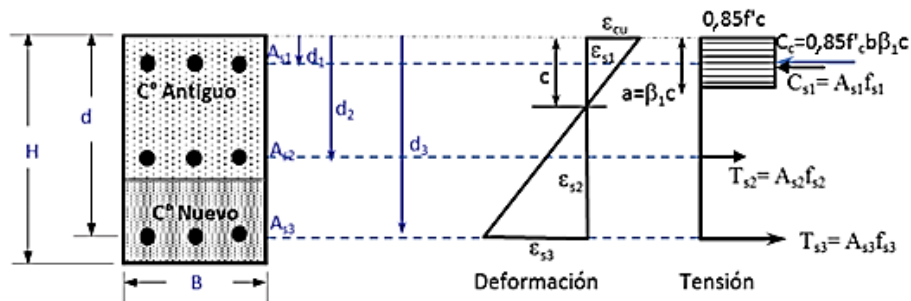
Reforzamiento de una viga con concreto armado en la cara inferior
